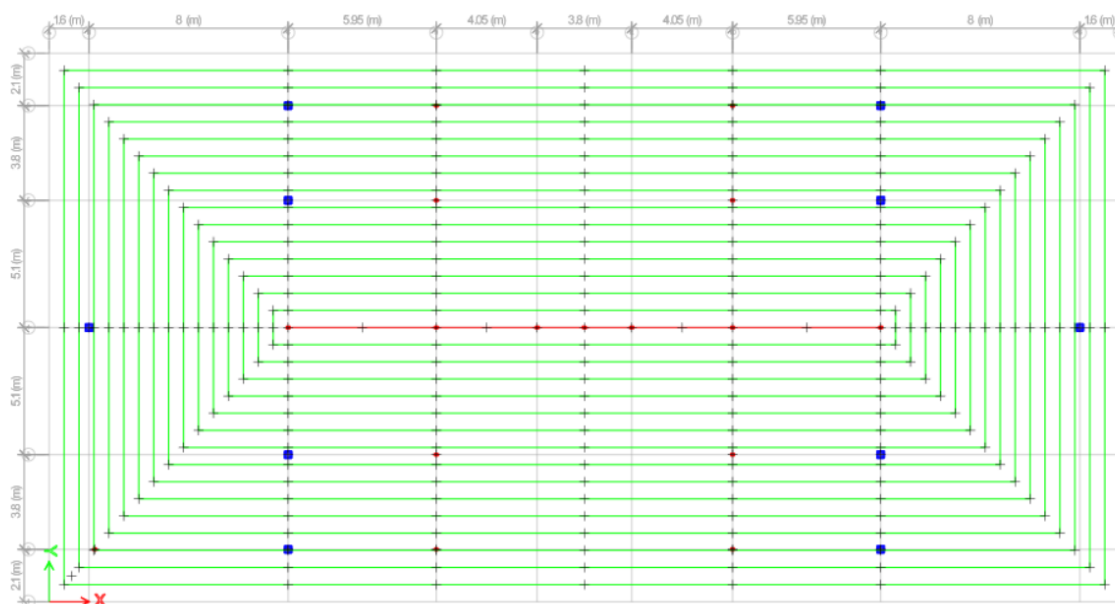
Vista en planta cubierta a 4 aguas de la edificación.
